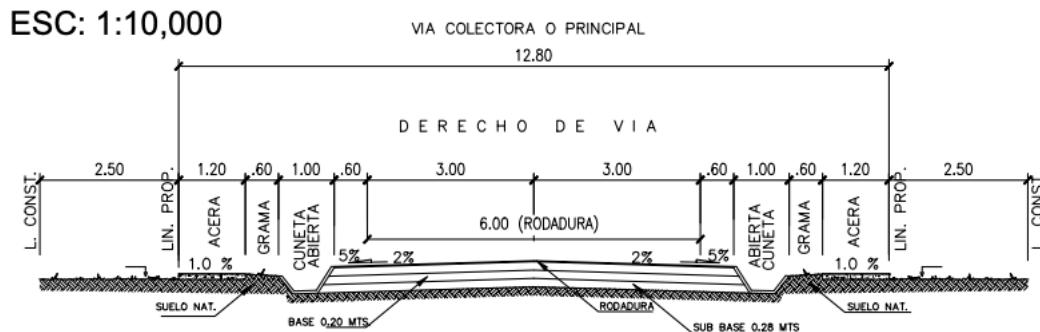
Sección de calzada de 12.80 metros de ancho.
